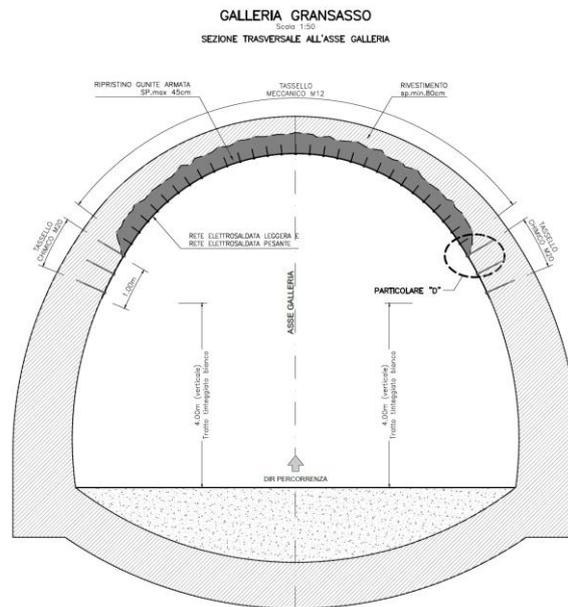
Rappresentazione tipologica C4B su sezione trasversale galleria
